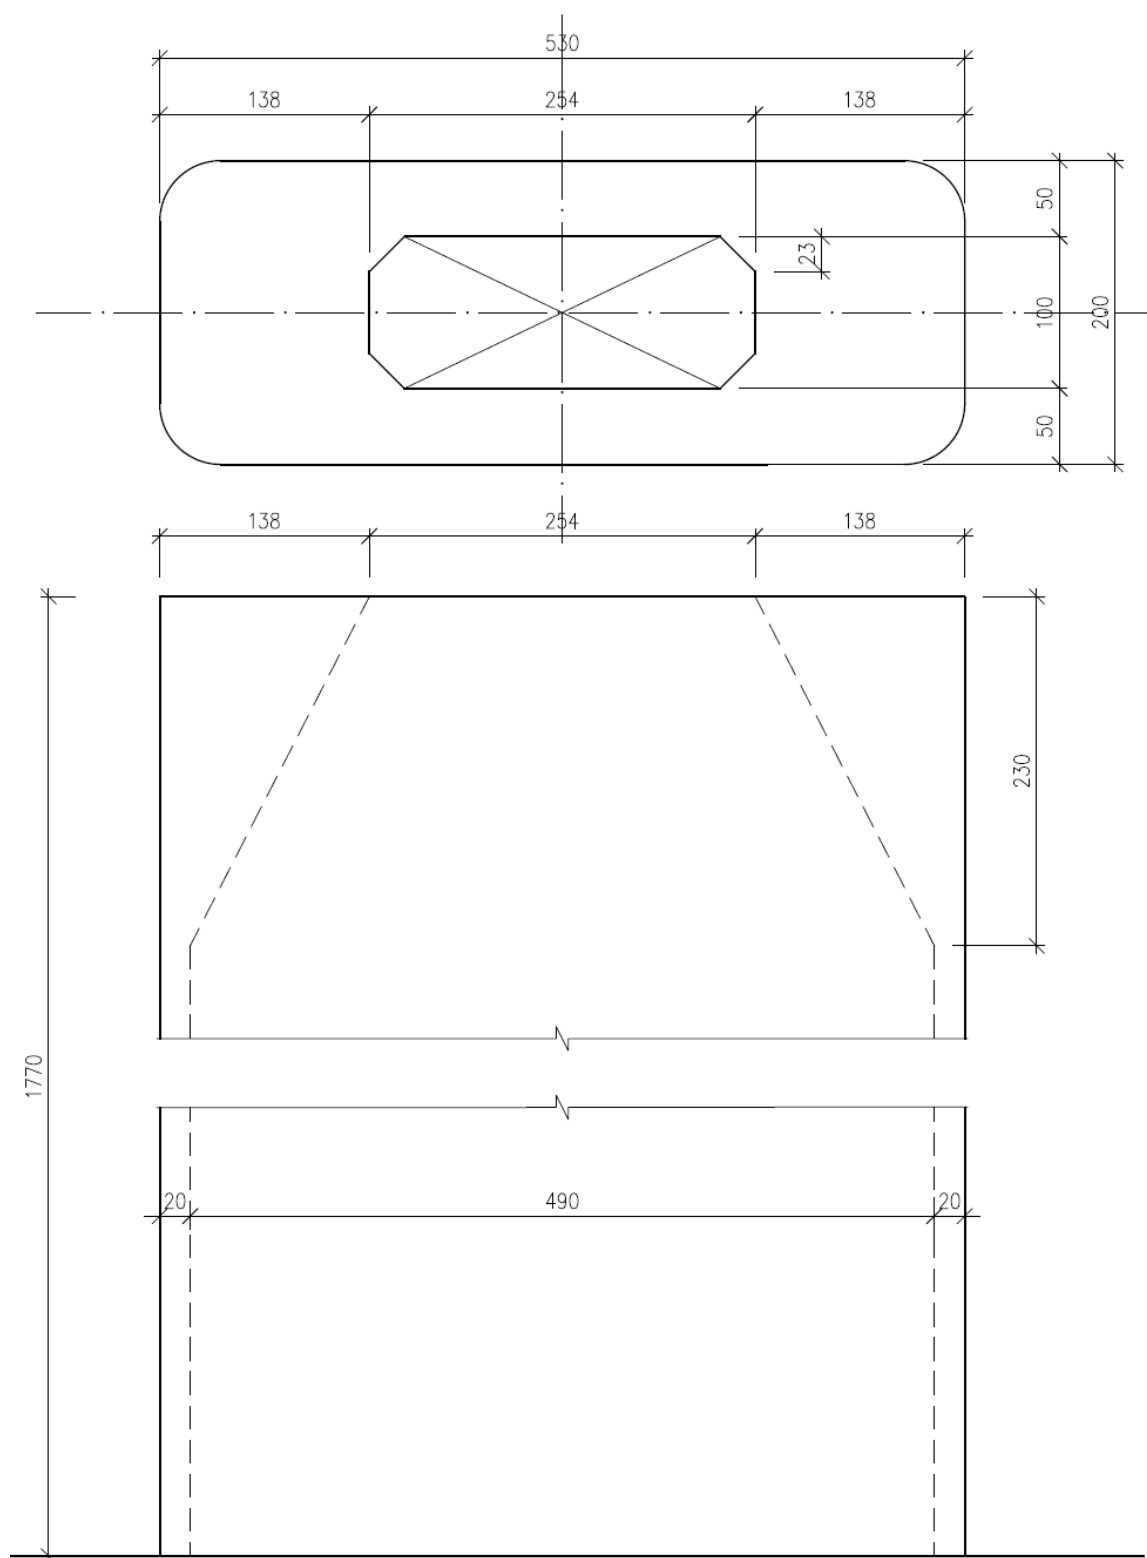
geometria dos pilares de seção caixão do vão de navegação junto ao Gerber
